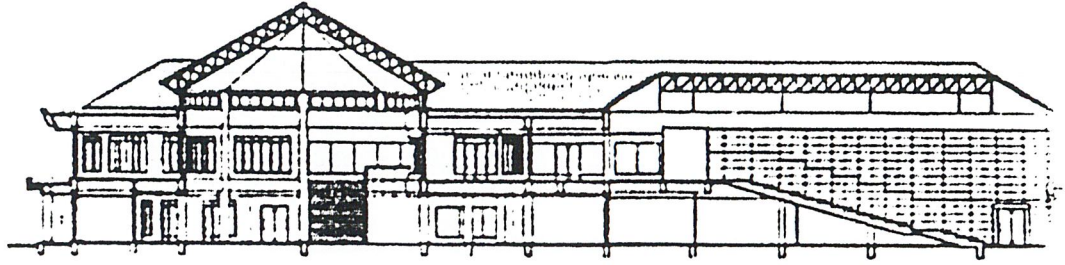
รูปด้านอาคารมองไปทางทิศใต้ (South Elevation)
